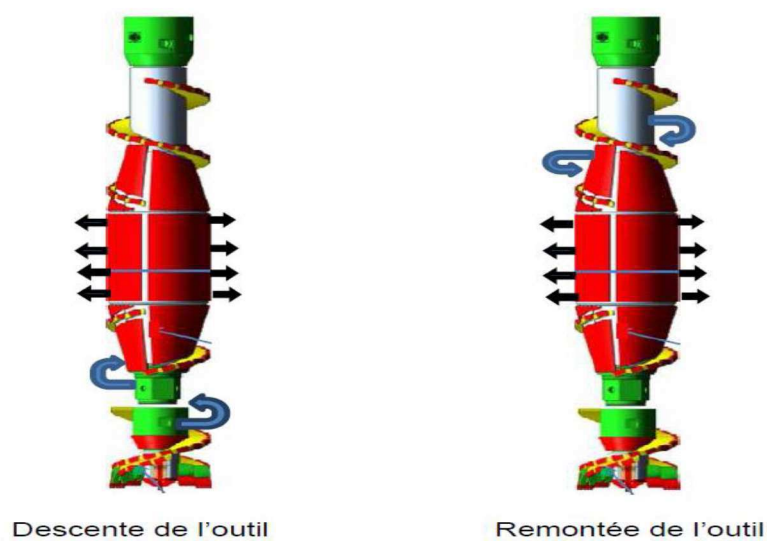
Principe du refoulement du sol par l'outil INSER
